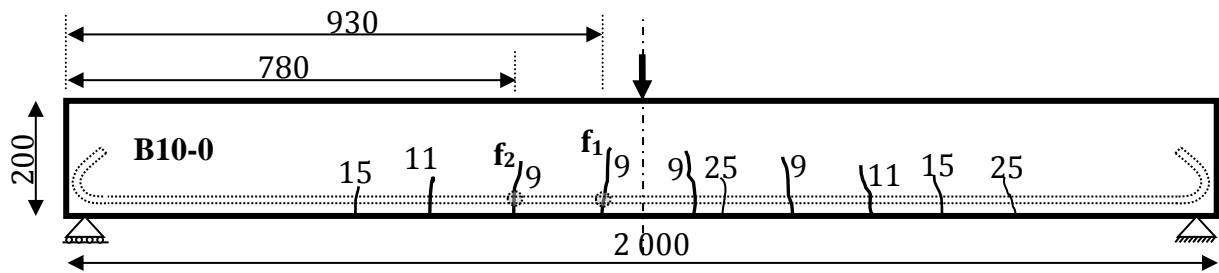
Cartes des fissurations de la poutre B10-0 au niveau de pré-chargement de 13.5 kN.m.
